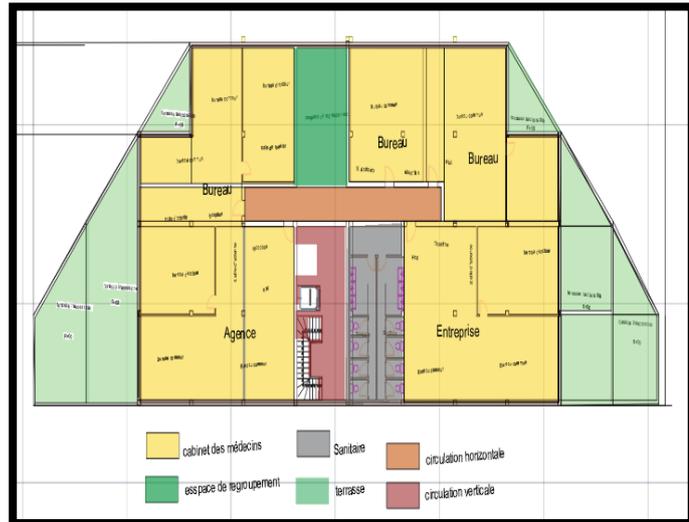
plan du 8^{eme} au 12^{eme} étage (source : auteur).
